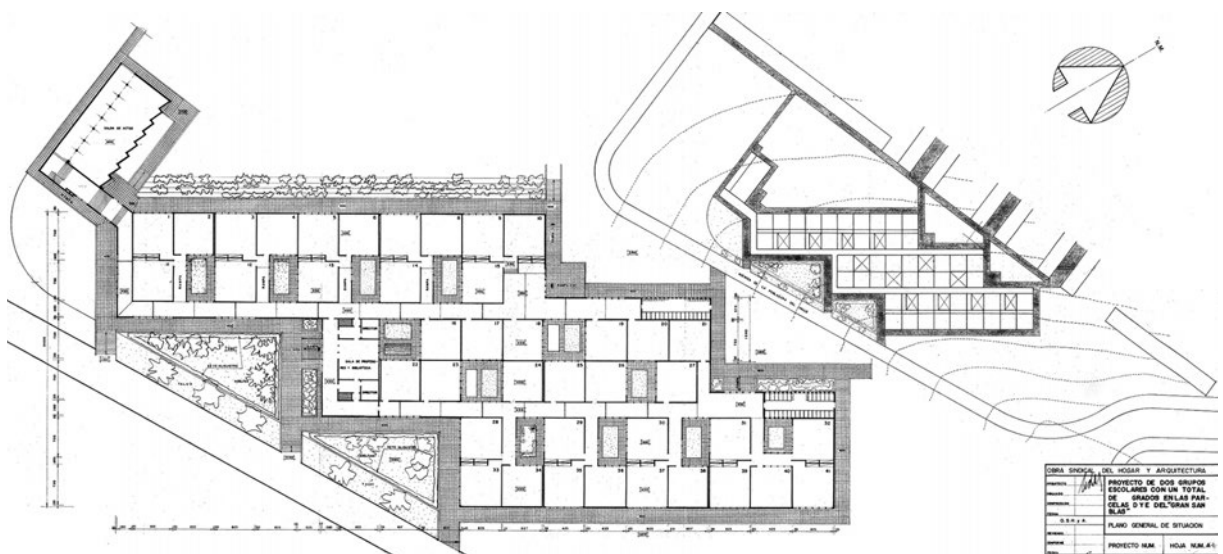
Situación y planta del proyecto. Imagen: Archivo General Universidad de Navarra, 201 (AGUN / 201).
